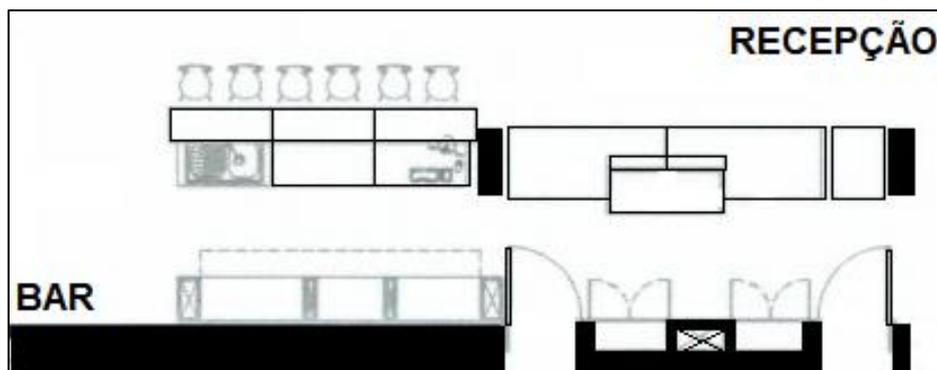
Planta baixa da recepção e bar (PPCI, 2018)
